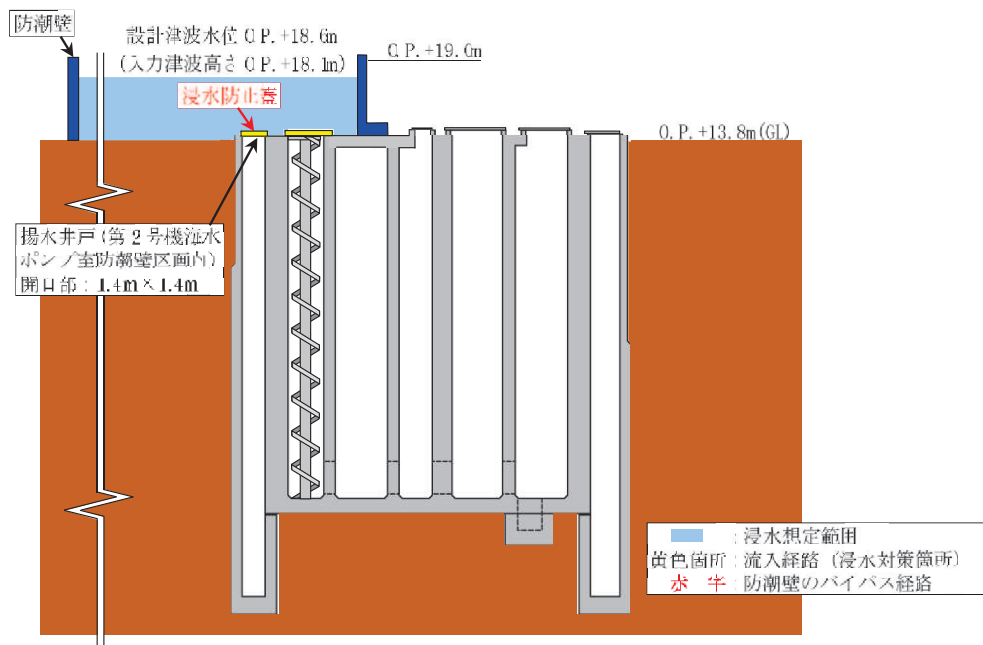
(2) 第 2 号機 海水ポンプ室 流入対策配置図 (B-B 断面図)
